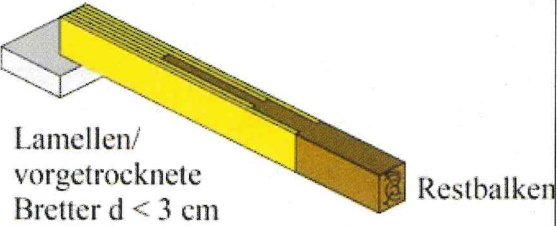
Auflagerausbildung Balkenkopf / Mauerwerk [1]
